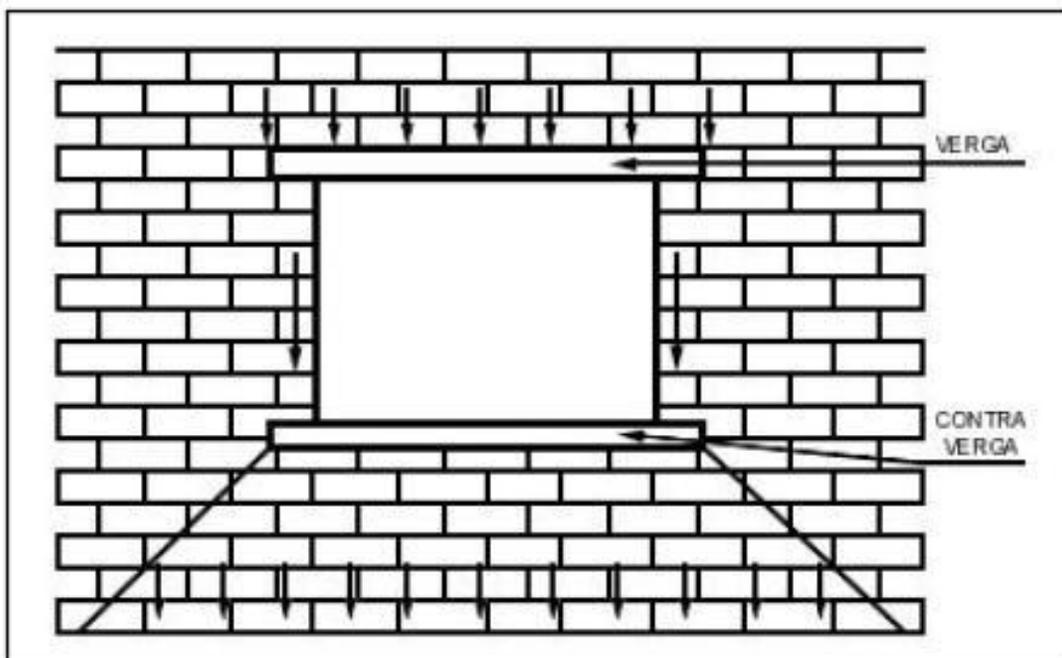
Posição da verga, contra verga e linha de fissura da alvenaria abaixo da janela.
